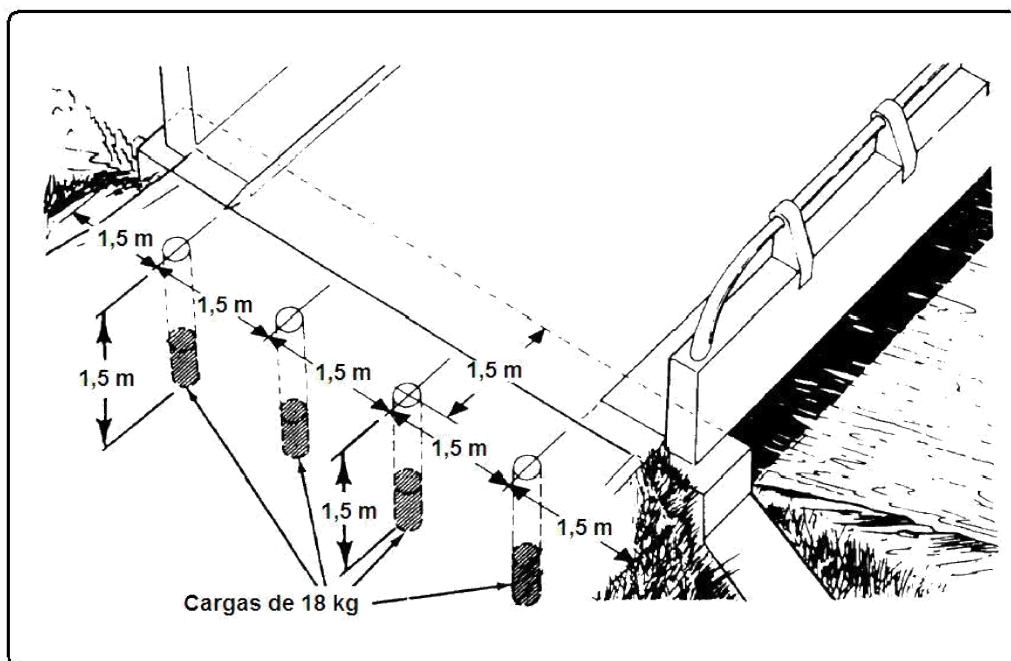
Demolição de encontros com menos de 1,5 metros de espessura
